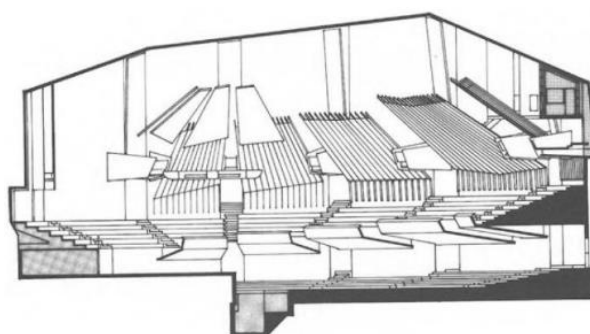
Christchurch Town Hall, planta e cortes (Beranek, 2004)
